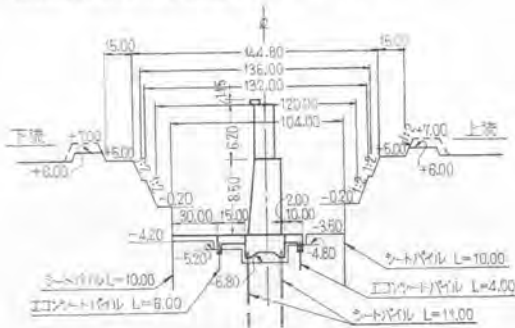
秋ヶ瀬取水堰地点掘削標準断面図
